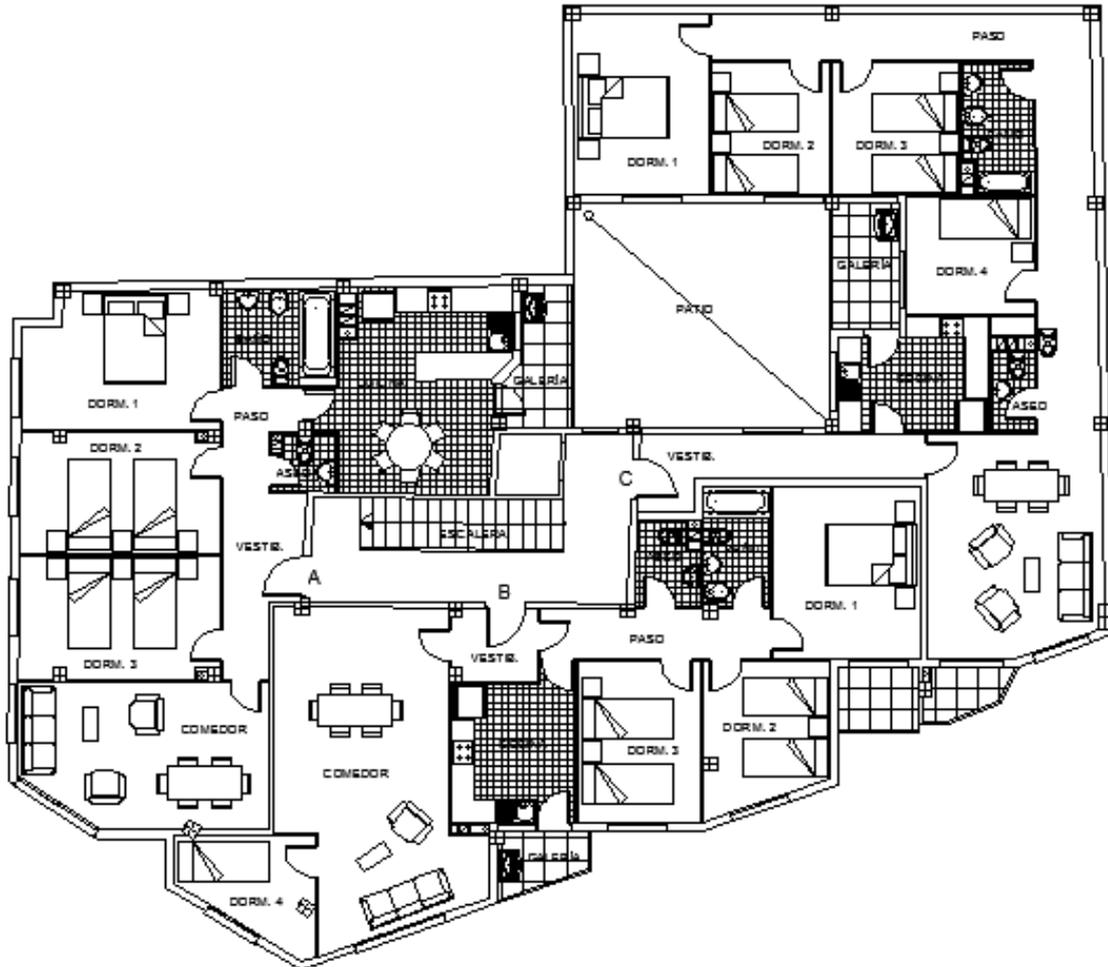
Situación PLANTA TIPO VIVIENDA edificio avd. Francia nº39 Vila-real (Propia).
